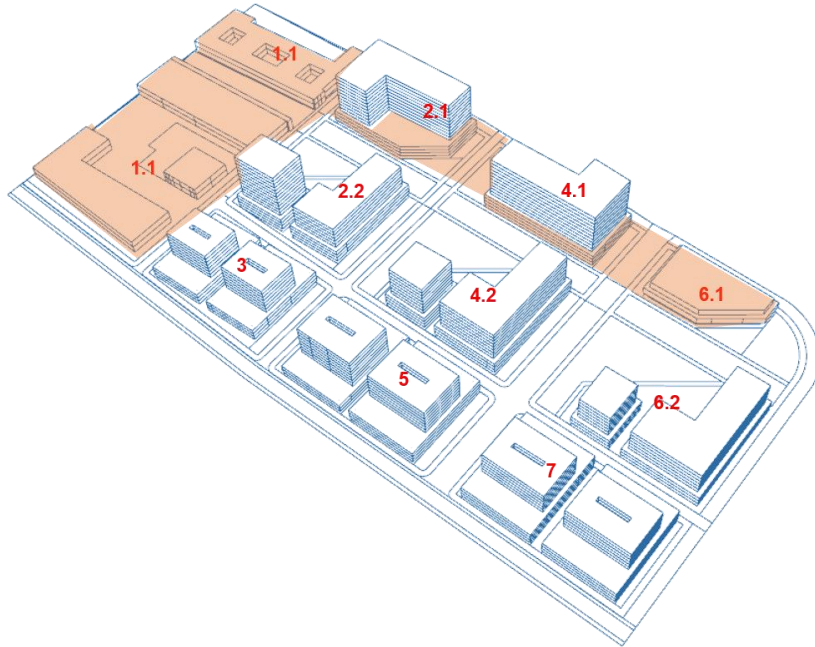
Planteamiento en planta de la propuesta de Plan Parcial.
